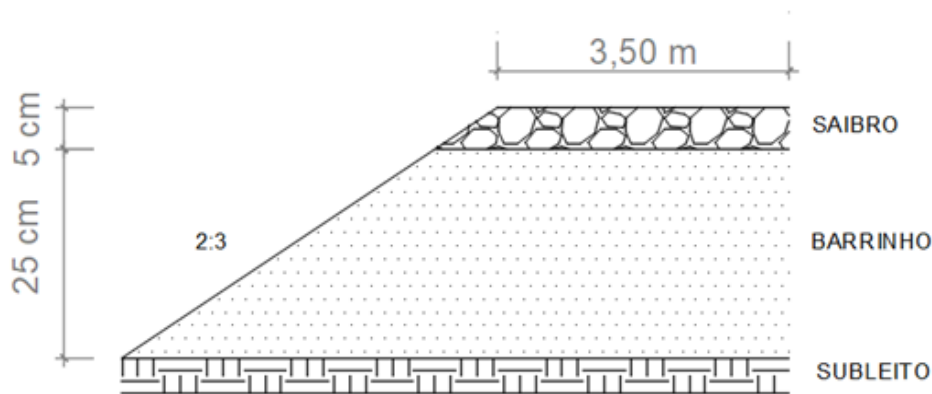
Representação esquemática das camadas do pavimento (s/ escala).
